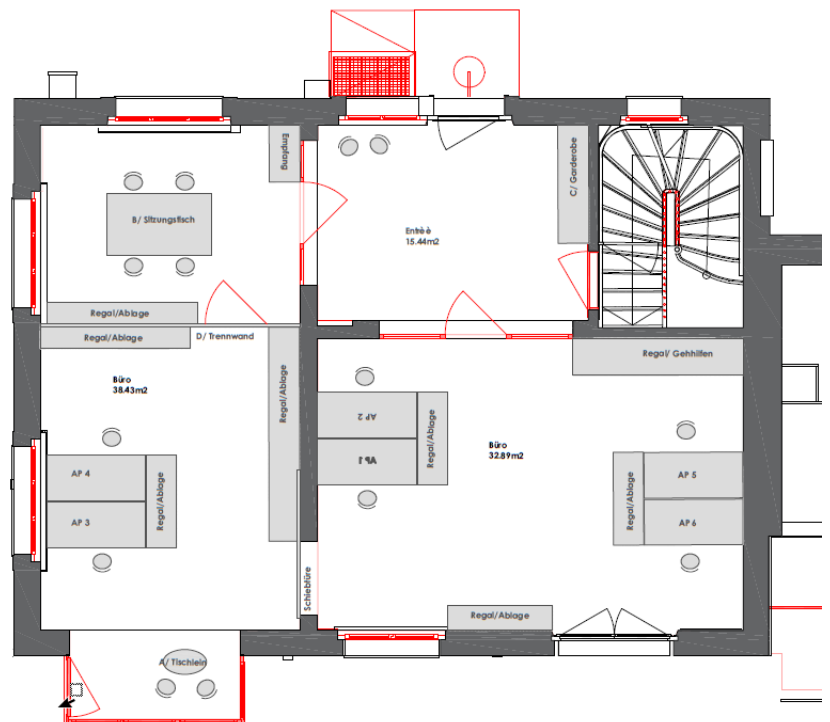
Grundriss EG Hauptgebäude, Variante
